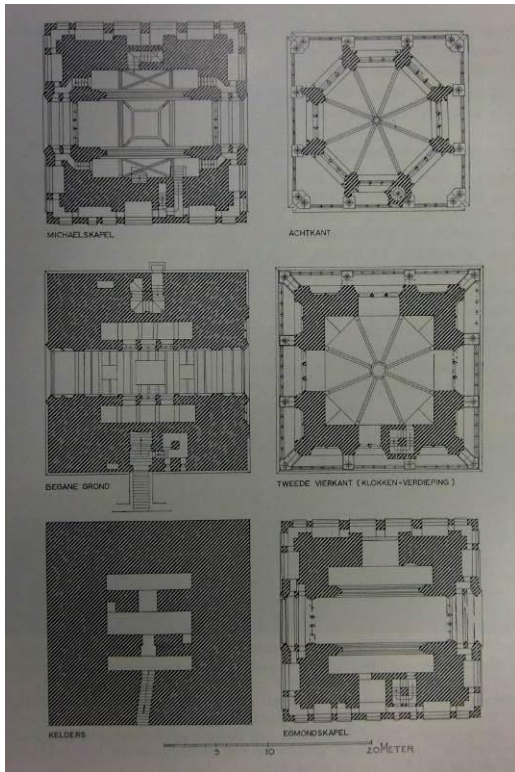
Grundrisse des Utrechter Domturmes
